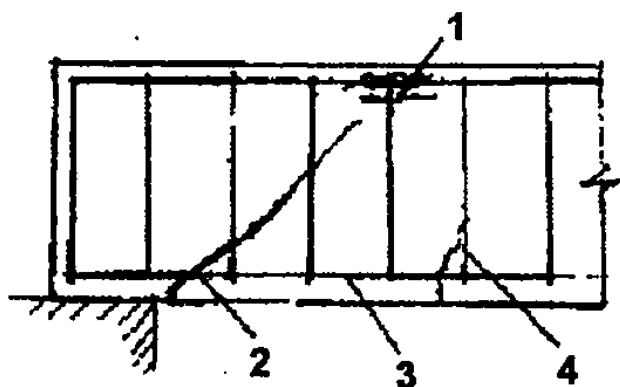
Схема руйнування залізобетонного елемента по похилому перерізу через просмикування арматури на вільній опорі:
